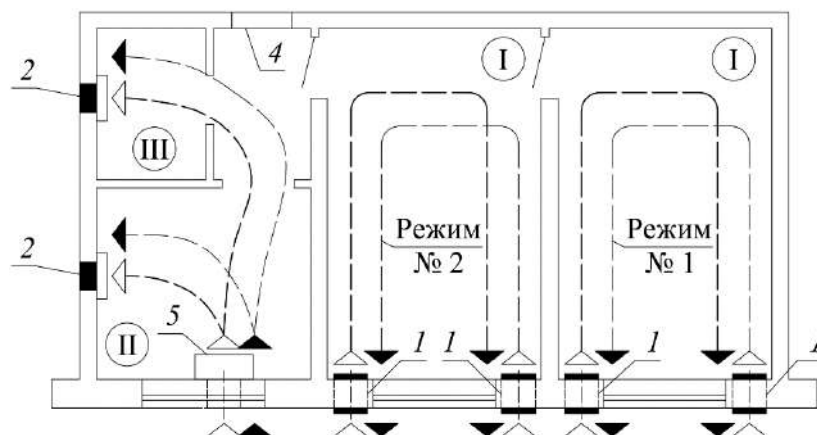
Движение воздуха в квартире с двумя приточными клапанами на комнату: I...III и 1...4 – см. рис. 2; 5 – комнатный воздухообрабатывающий агрегат [2]
